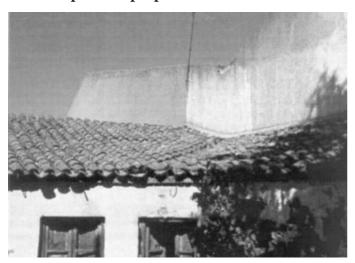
Detalle de zona este, medianera con el garaje Santa Teresa
